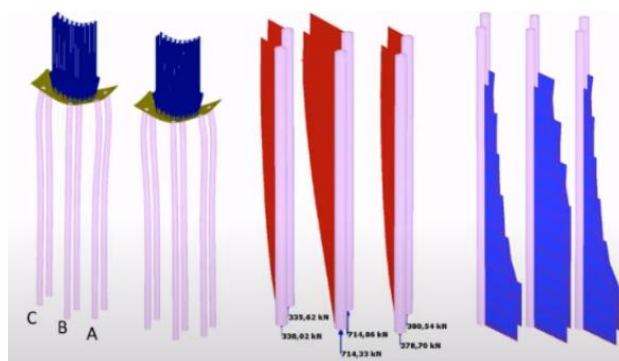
Расчет свай при помощи инструмента «Embedded beam»
